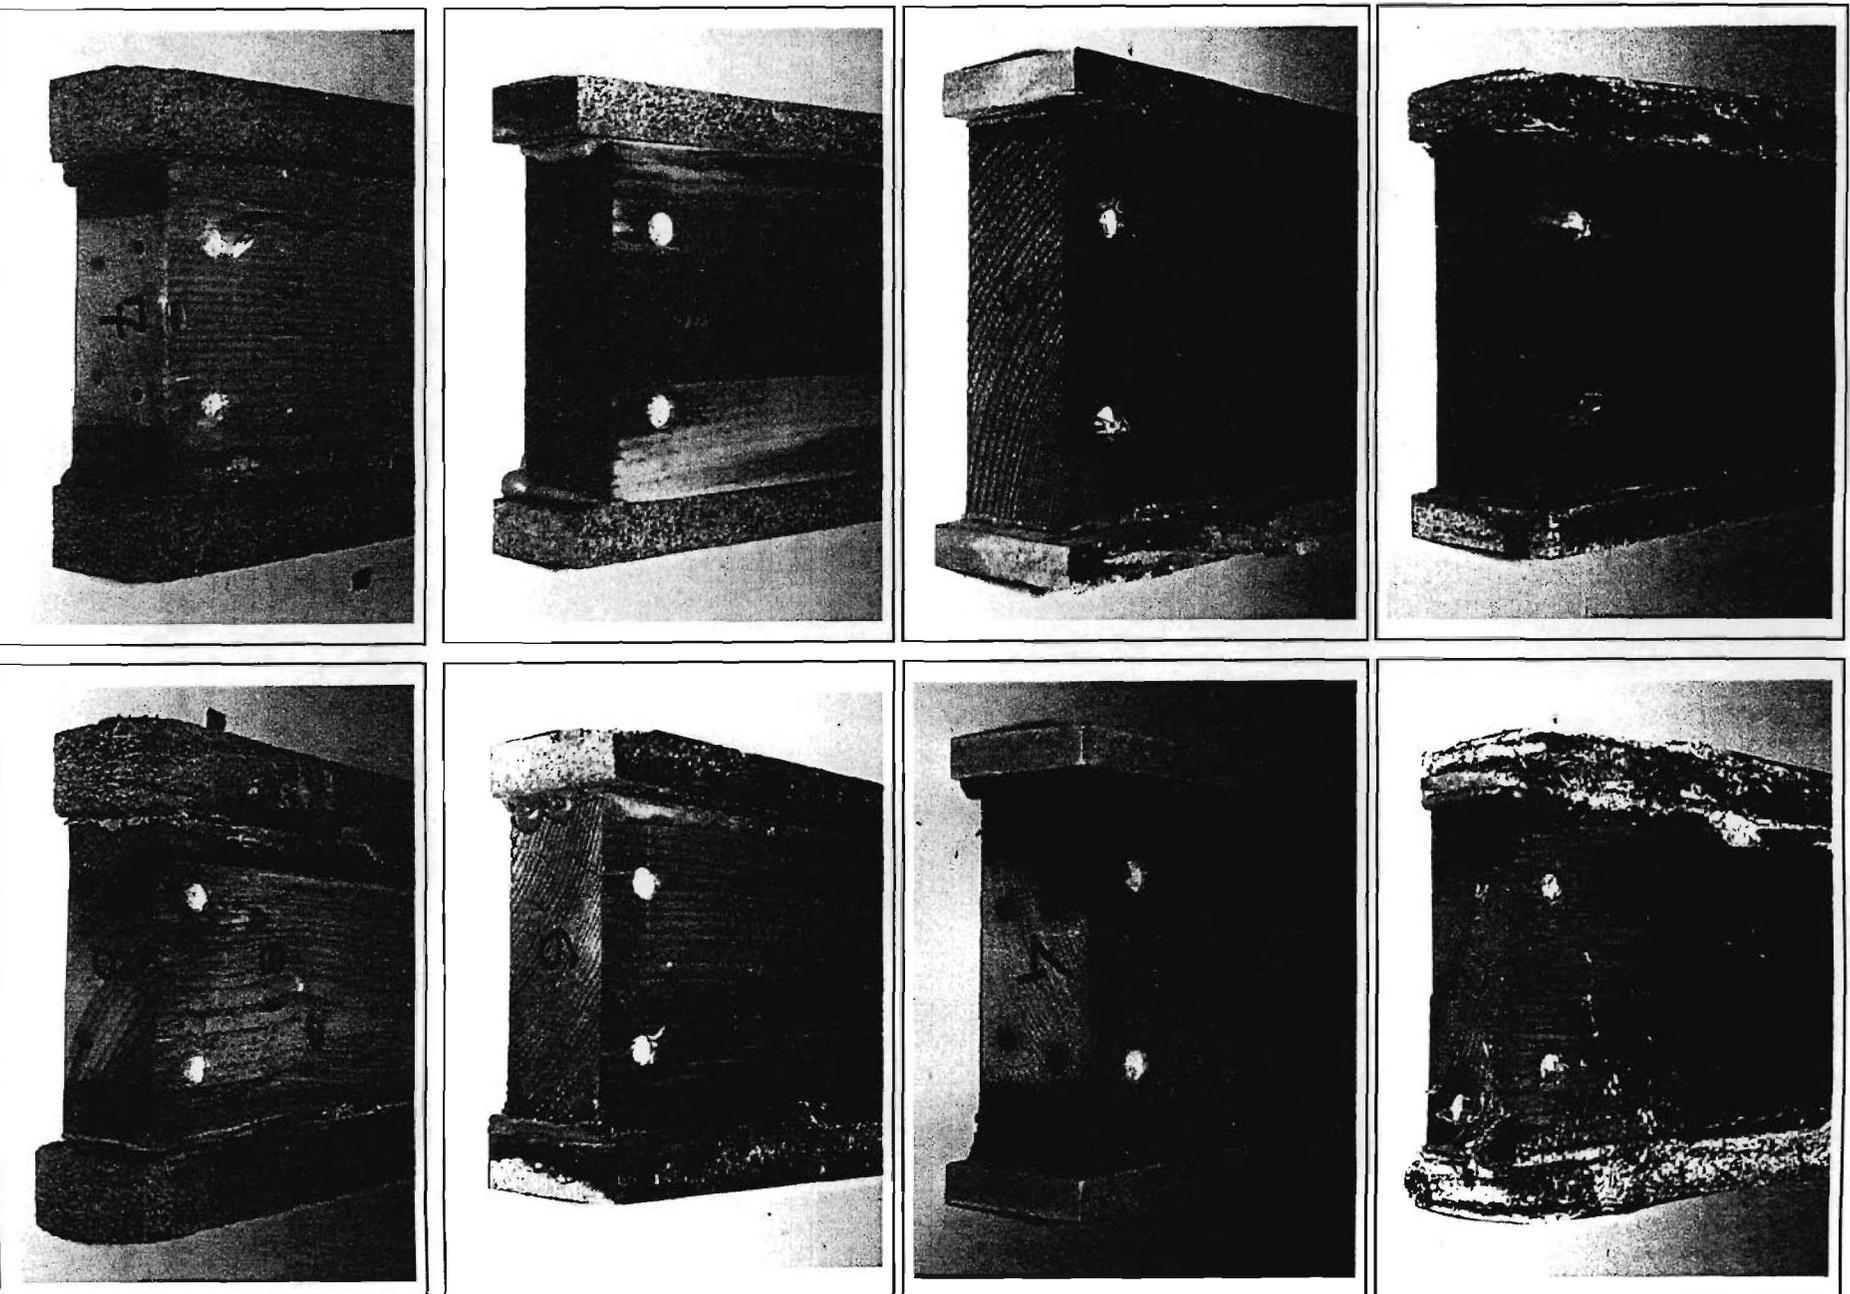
Ansicht der Wandelement-Obergerüste nach 24jähriger Bewitterung unter Dauerlast
